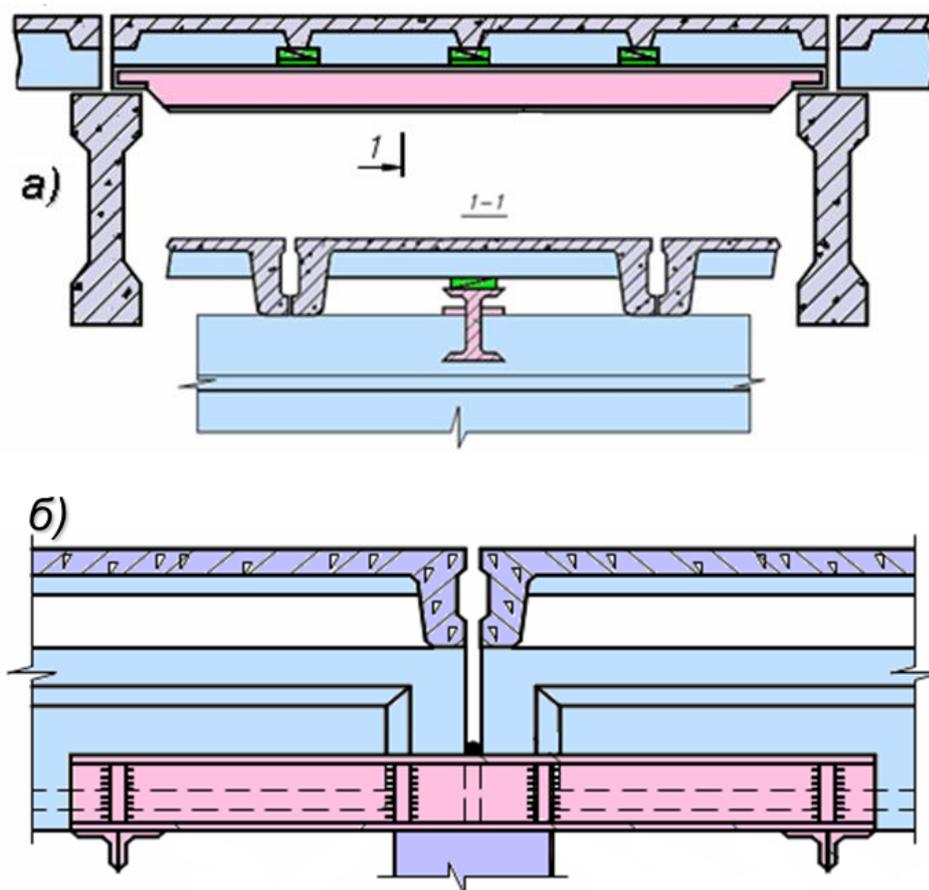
Усиление железобетонных конструкций дополнительными упругими опорами:
